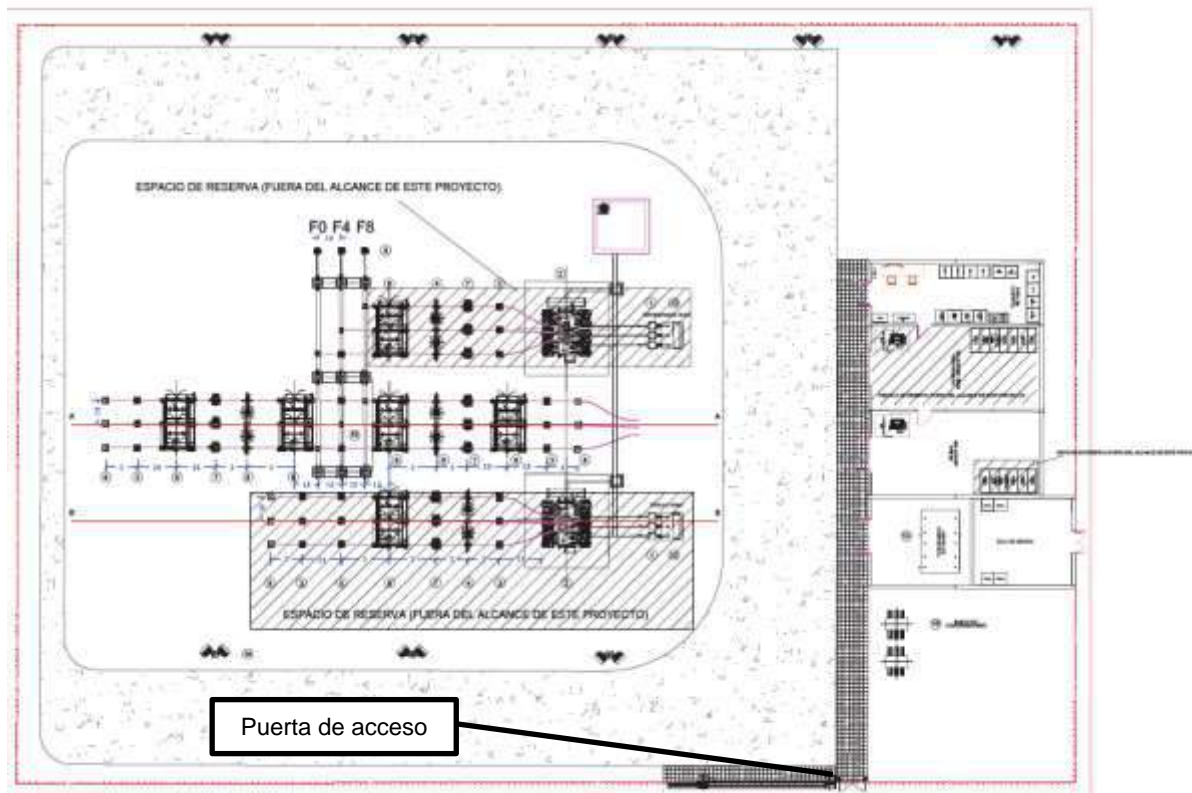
Puerta de Acceso a la Subestación Colectora/Elevadora.
